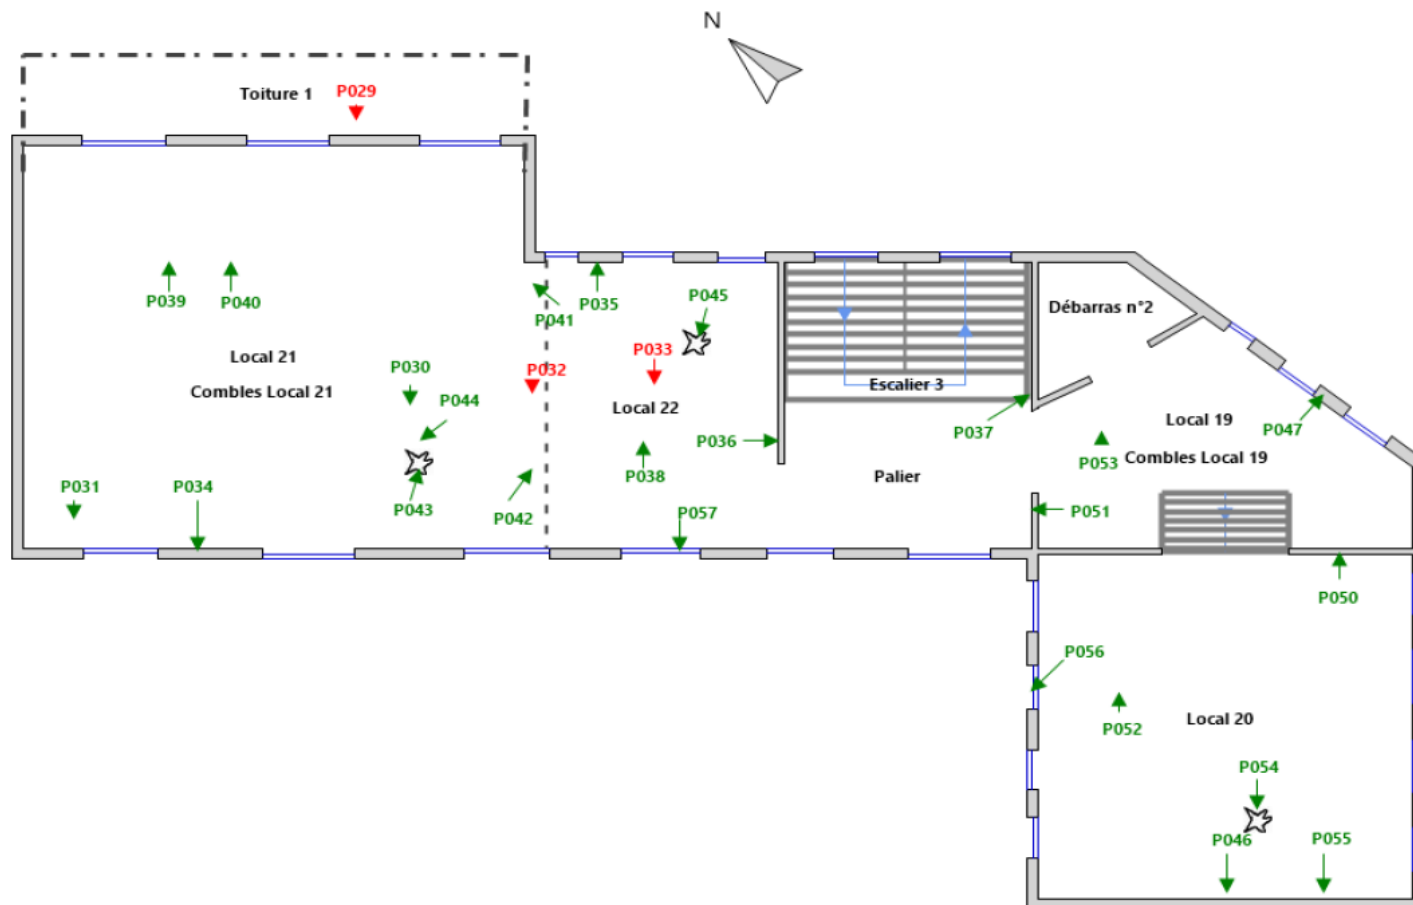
Plan du RDC des prélèvements amiante dans le bâtiment
